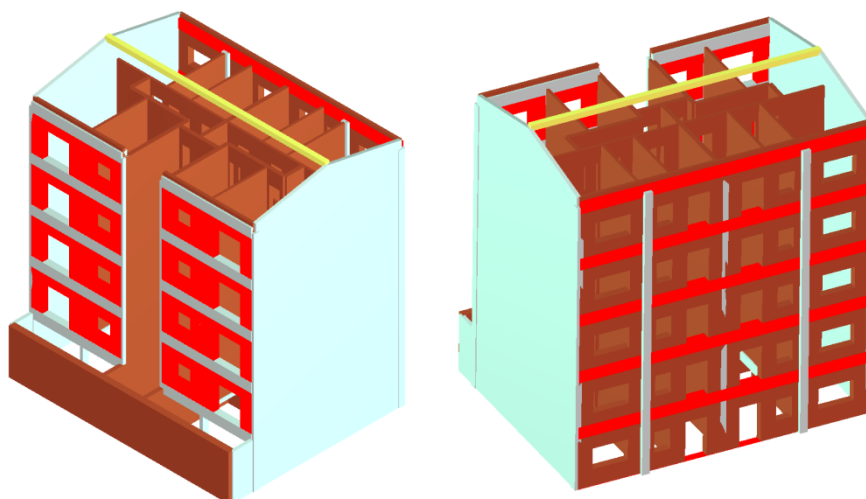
Esquema de introdução do reforço de fibra de carbono nas vigas da fachada de tardo, e reboco armada na fachada principal
